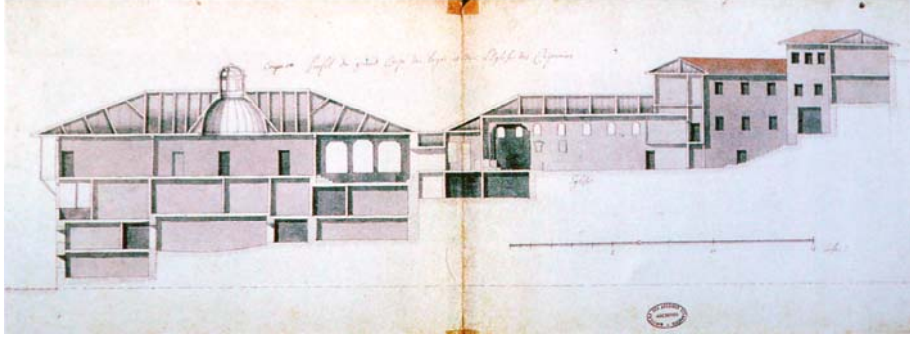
Fransız Sarayı plan- Pierre Vigne de Vigny'nin hazırladığı rölöve çalışmasından-1721
